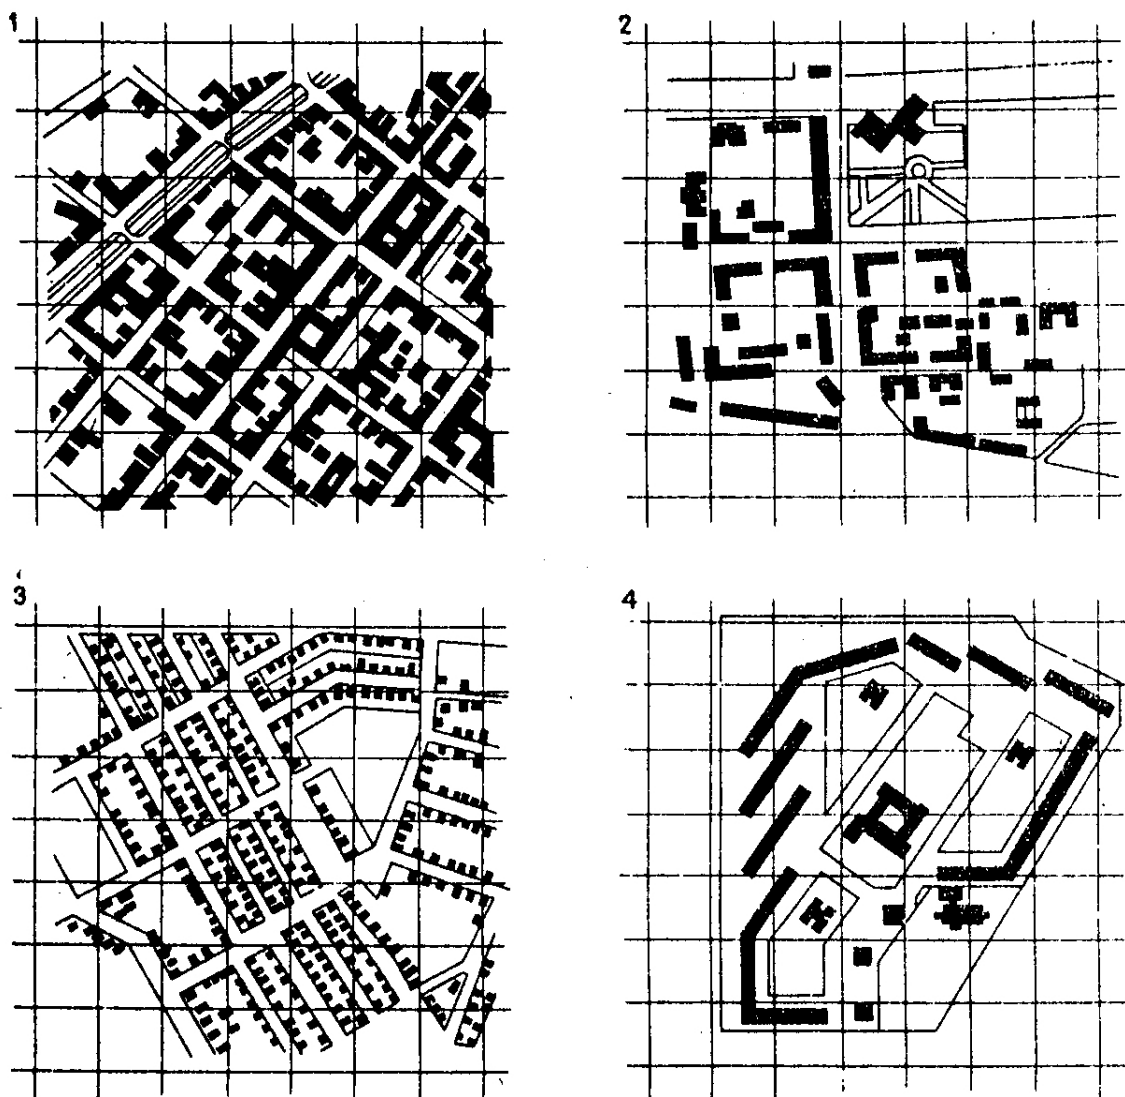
Типологічний аналіз прийомів житлової забудови: 1 – капітальна щільна забудова 19 в.; 2 – квартальна забудова; 3 - садибна забудова; 5 – сучасна багатоповерхова забудова з комплексом обслуговування.
